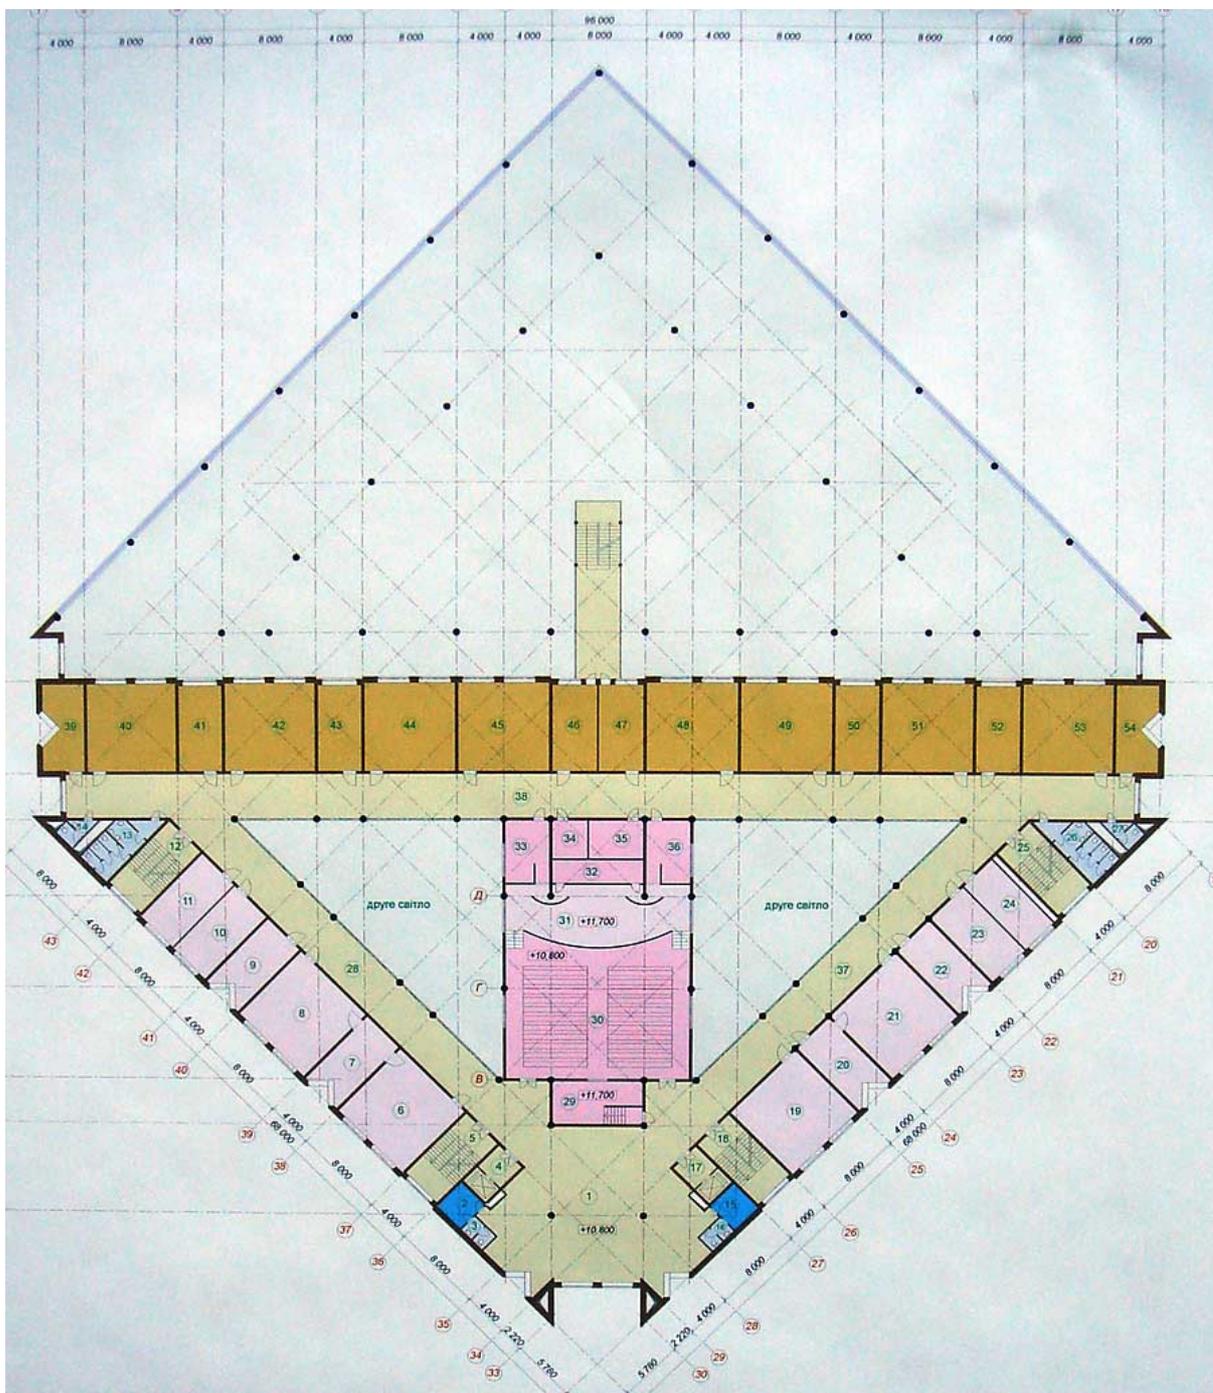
Решение плана этажа здания школы с использованием верхнего освещения помещений. Второй этаж.
